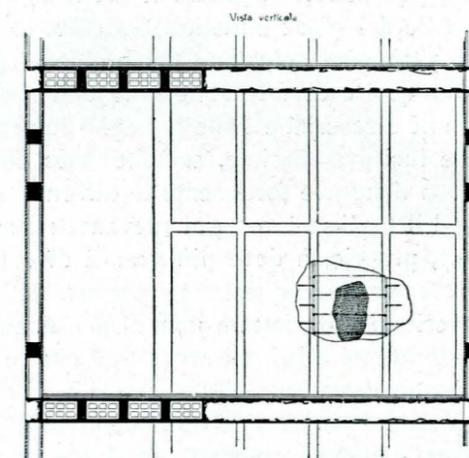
Vista verticale di un muriccio secondario da rivestire in lamiera stirata.
